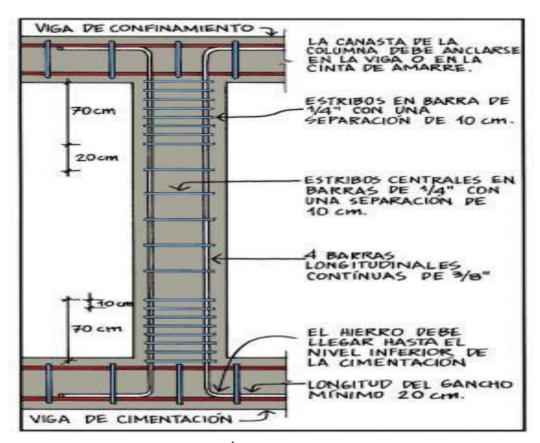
REFUERZO MÍNIMO EN UNA VIGA DE CONFINAMIENTO
